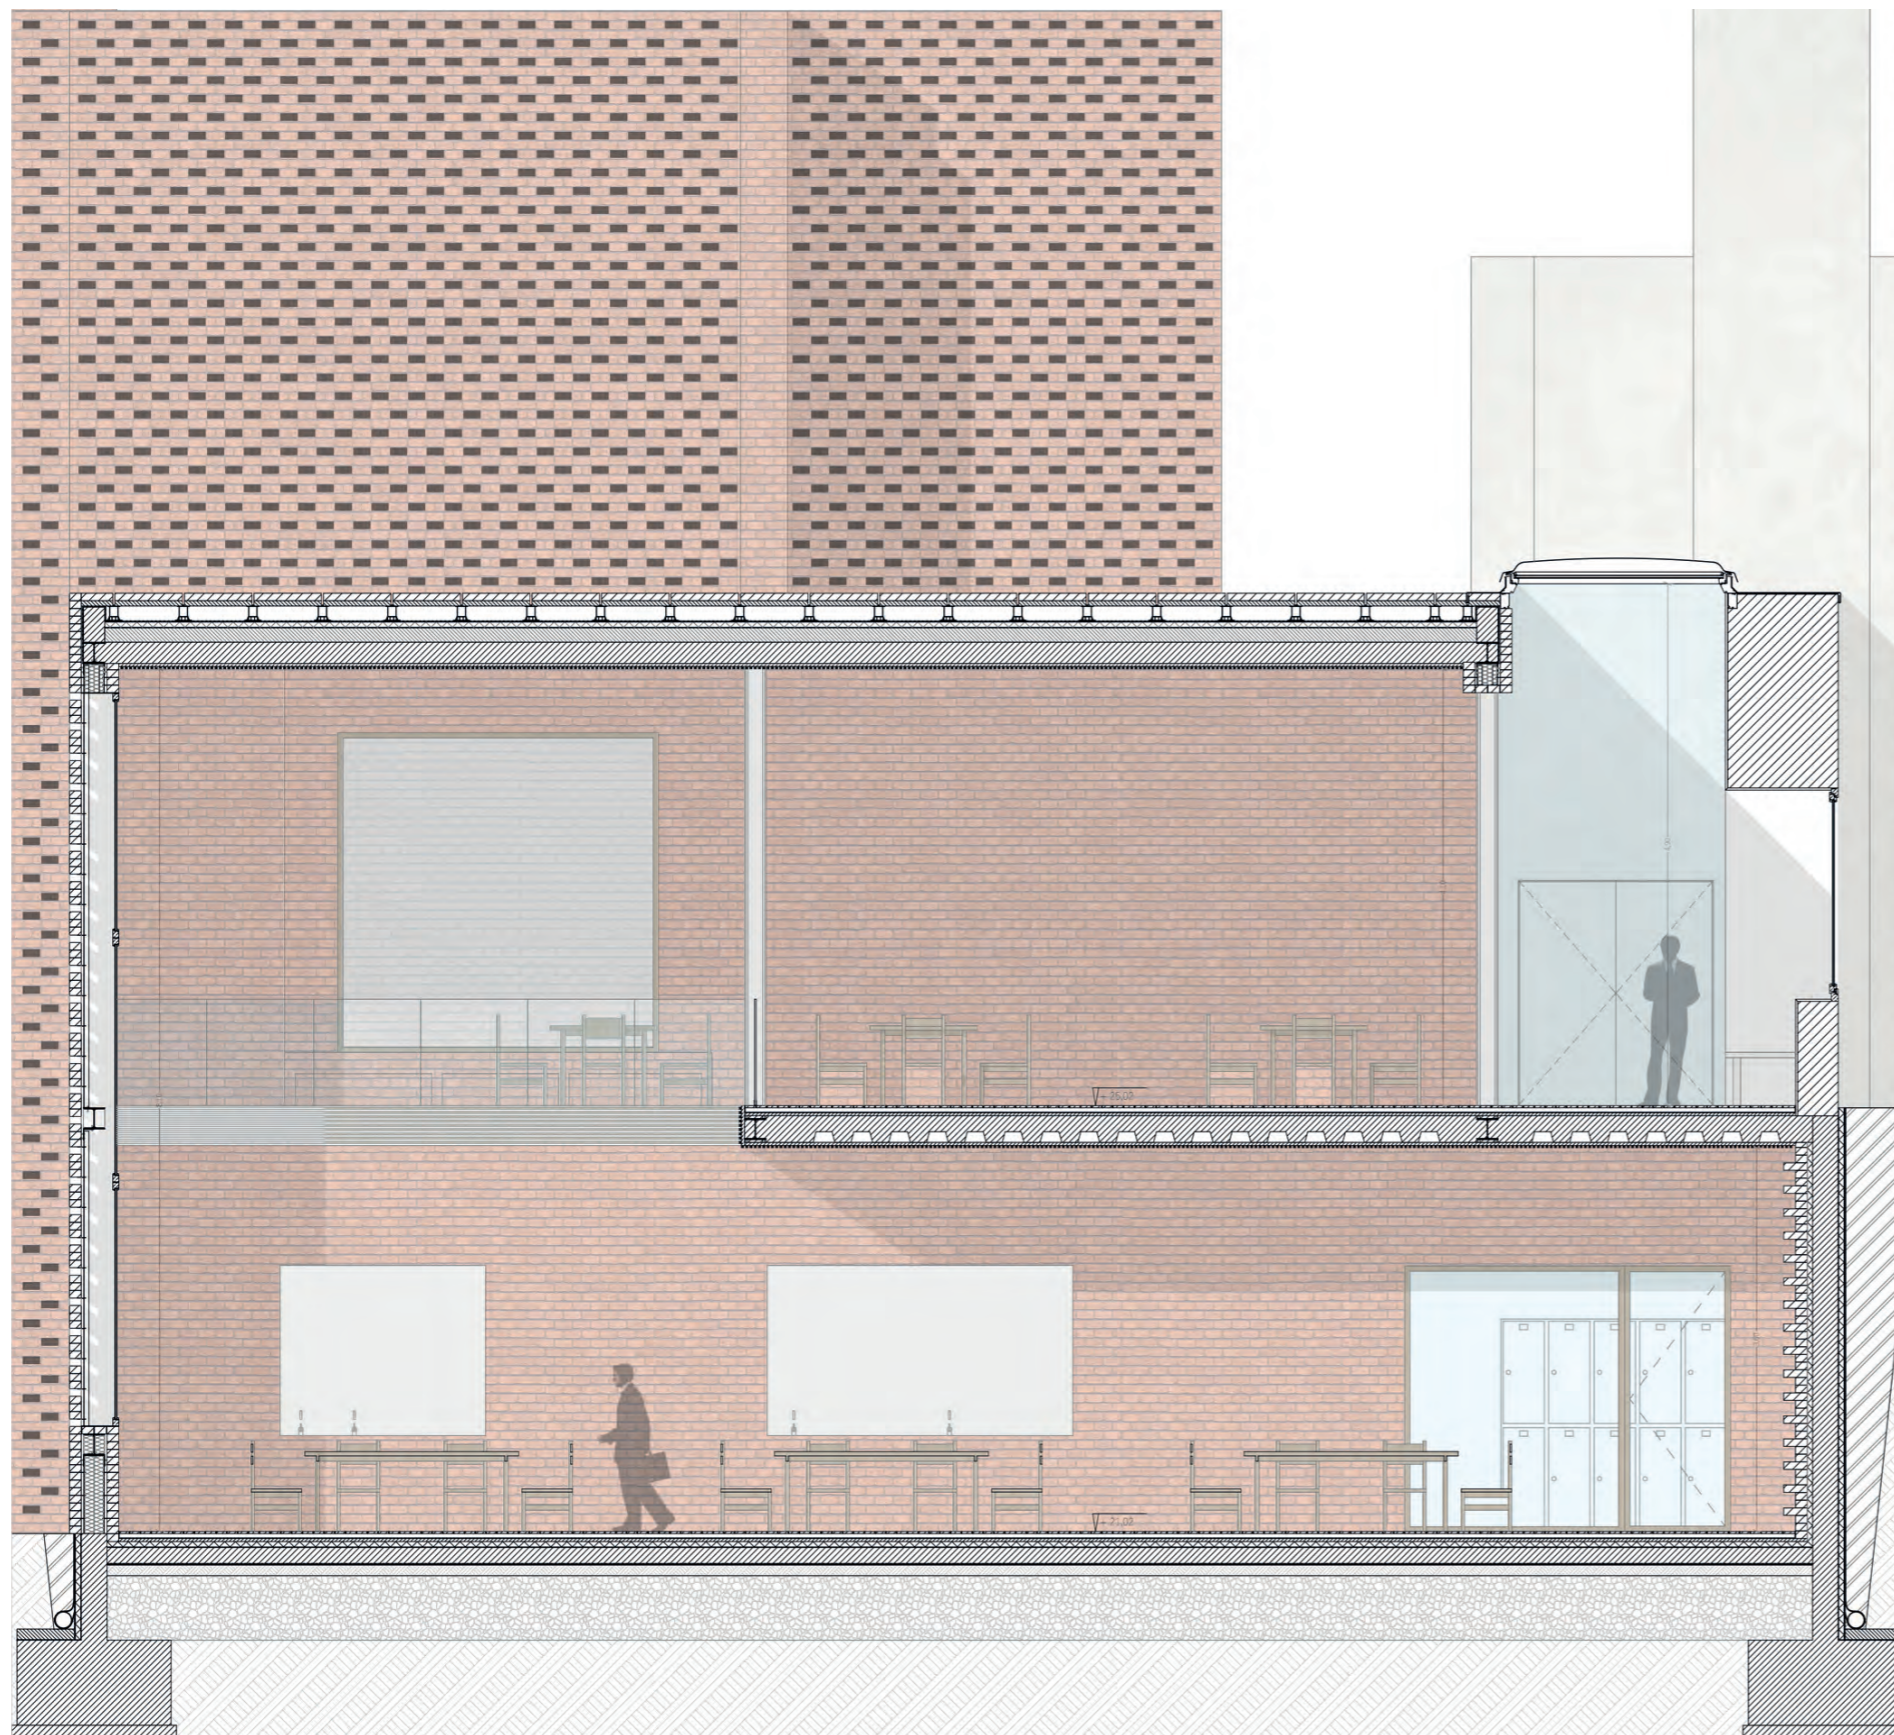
| Corte construtivo do novo edifício. Corresponde ao desenho nº 12 da proposta de arquitetura, presente nos anexos
